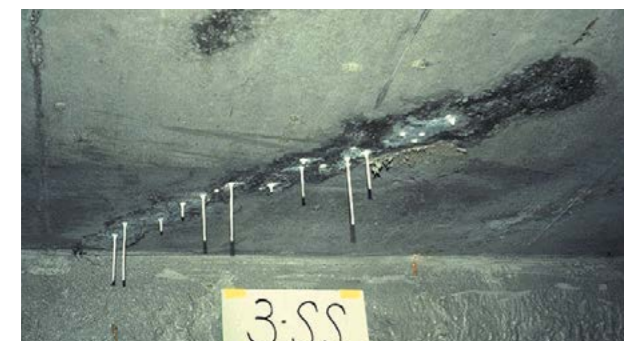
Durchgehende Risse mit Wassereindringung als Folge behinderten Schwindens in einer Parkhausdecke
